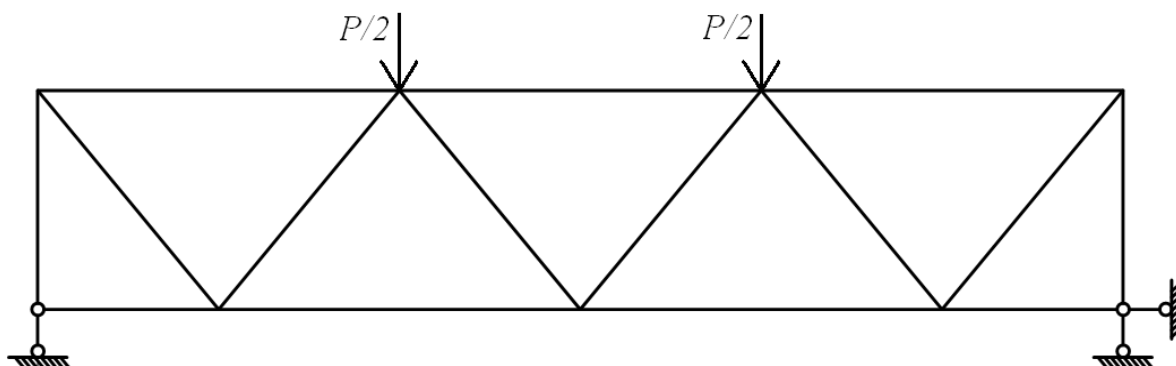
Схема базування і навантажування зварної ферми
